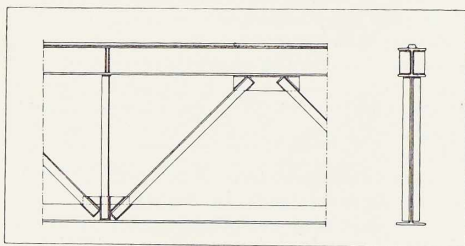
Poutre de pont roulant soudée. Vue des assemblages et disposition des cordons de soudure.
